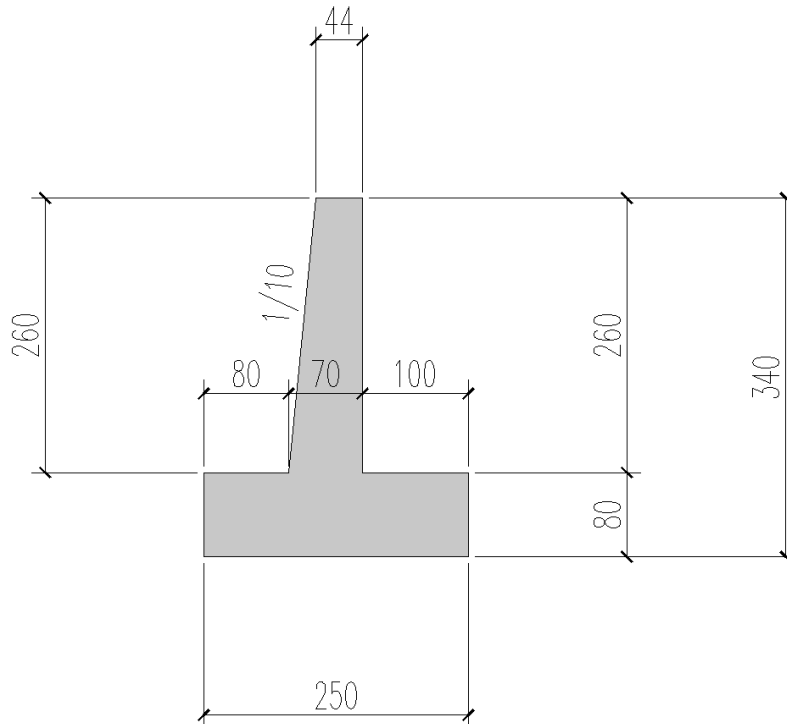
Carpenteria Sezione ad altezza maggiore del Muro M05
